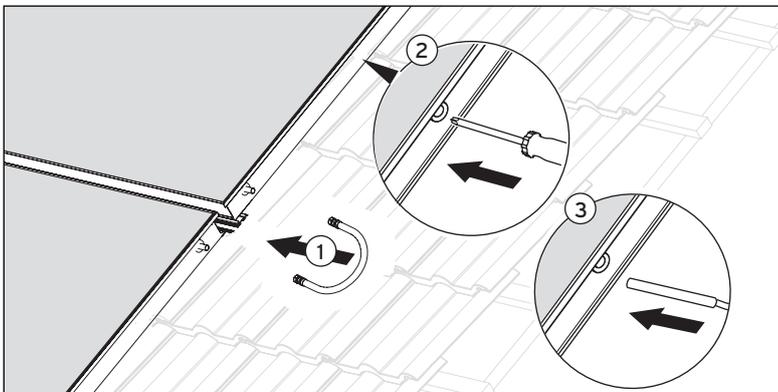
Collegamento reciproco dei collettori drainback VFK 135 D
